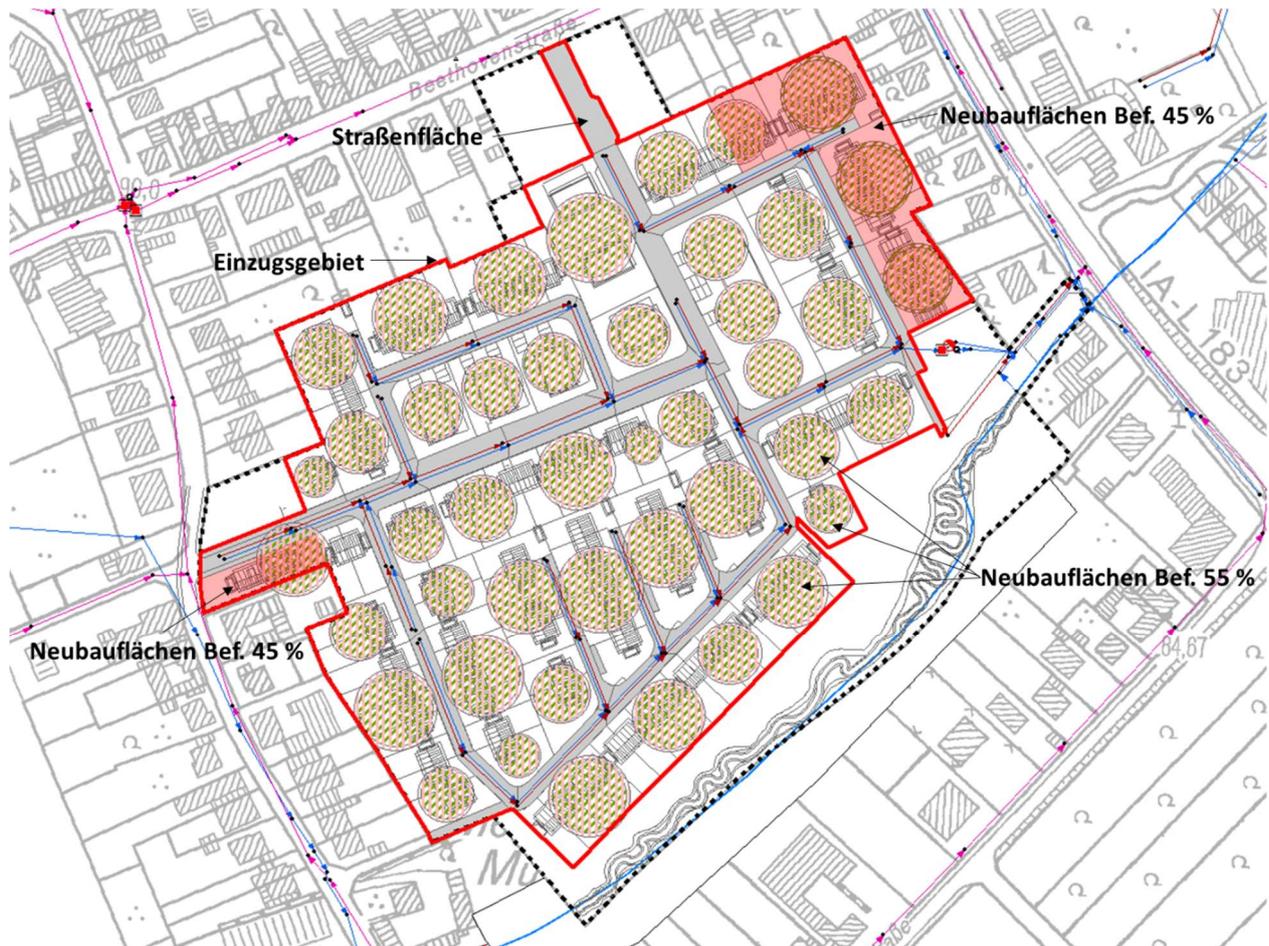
Grundstücks- und Straßenflächen im Plangebiet
